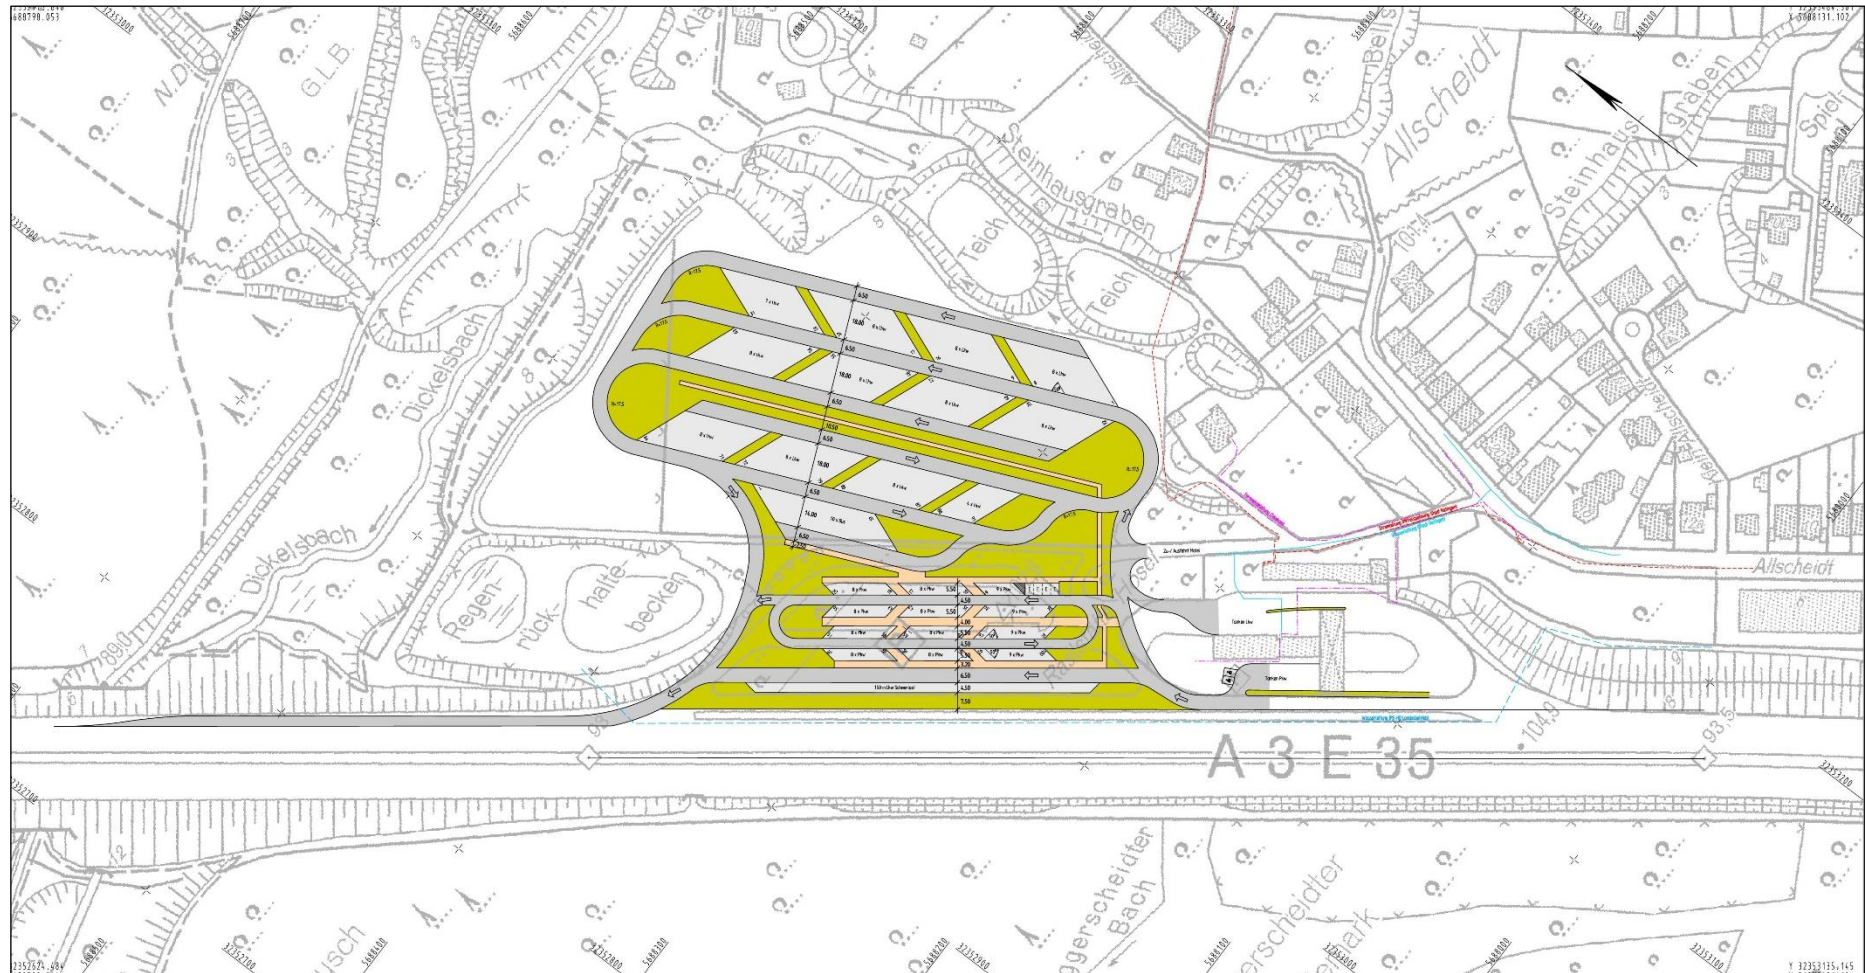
Lageplan der Variante 2 (Quelle: INGENAix GMBH 2018)
